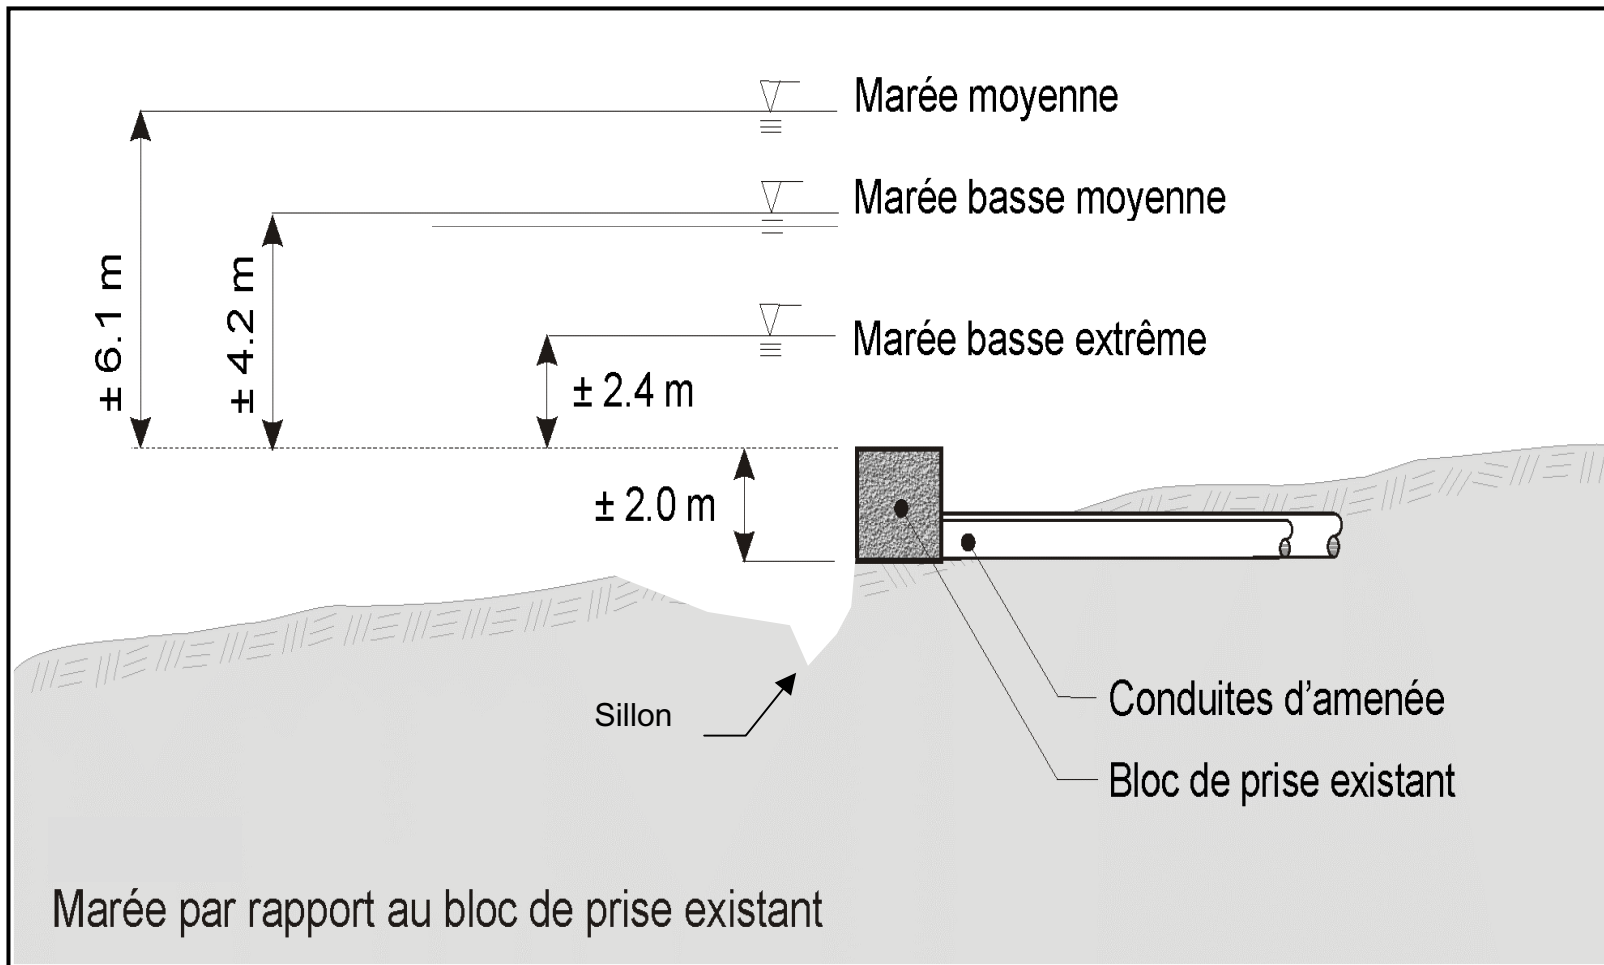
Hauteur de la marée par rapport au bloc de prise existant
